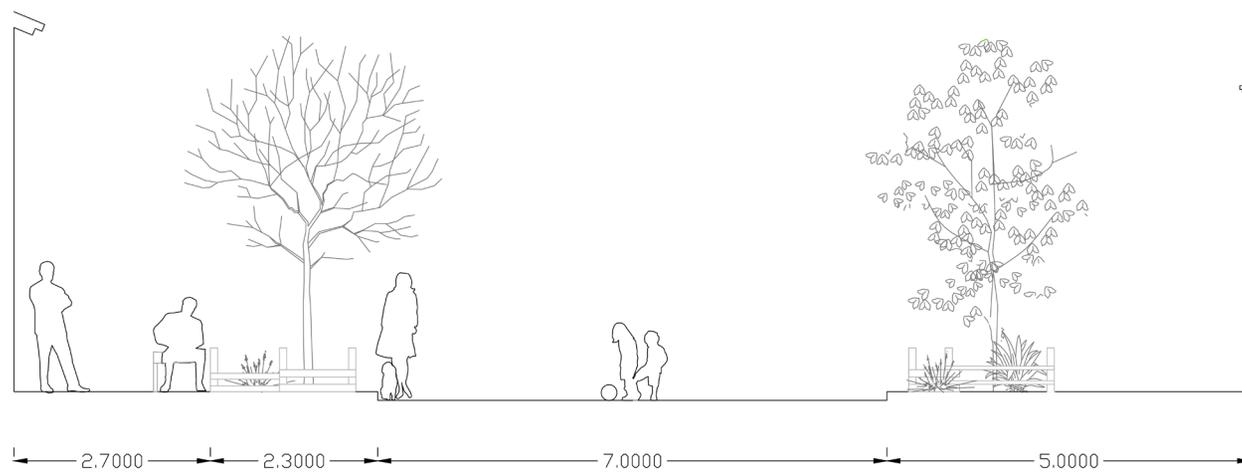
Perfil tipo de calles que posibilitan fiestas y ferias. Elaboración propia.
